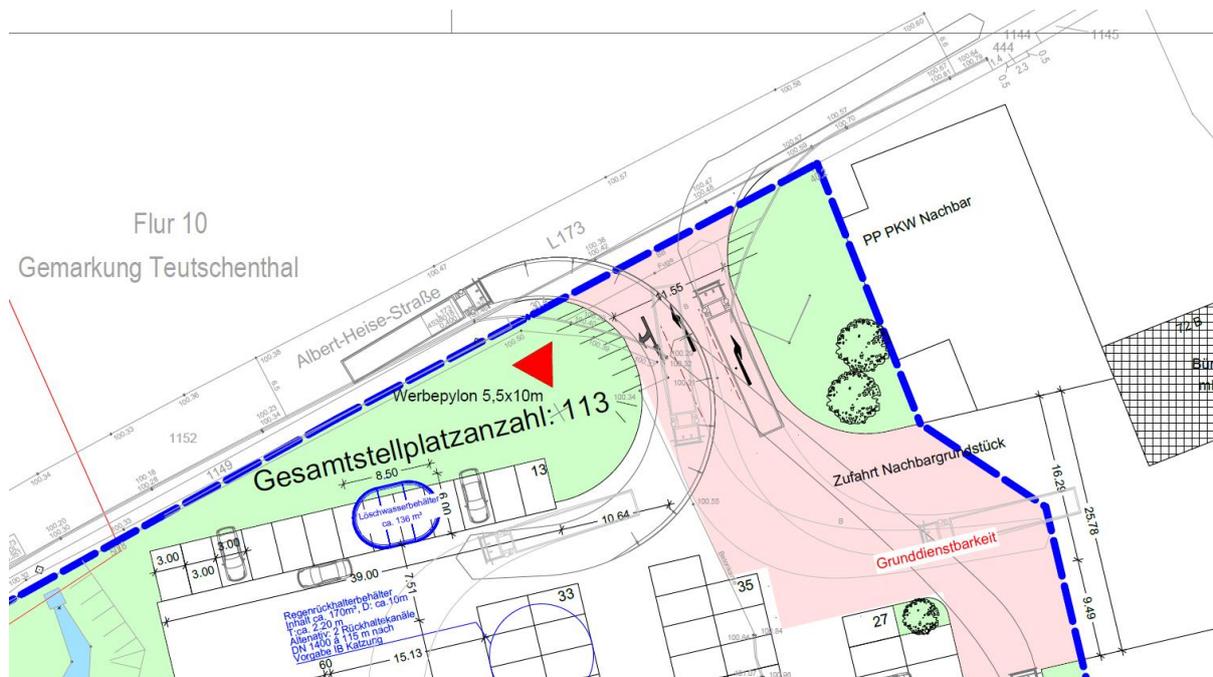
Auszug aus dem Lageplan zur Objektplanung (Entwurf: Dipl.-Ing. Michael Jope, Weimar (Stand: 15.12.2021)) – unmaßstäblich
